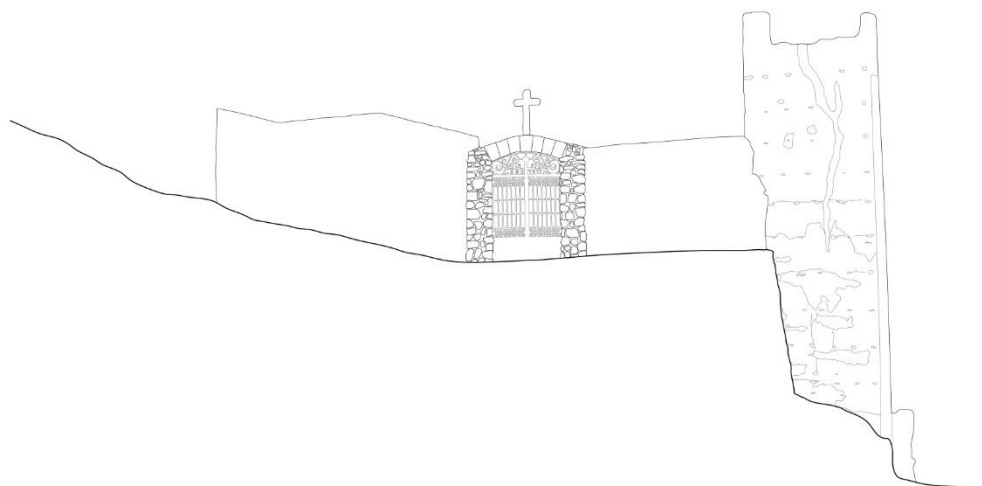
Unión cementerio y Torre A. Escala 1/200. Fuente: Autora.
